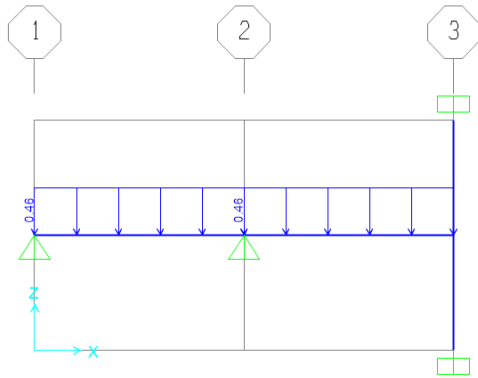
Modelo estructural de vigueta tipo II (ton/m)
